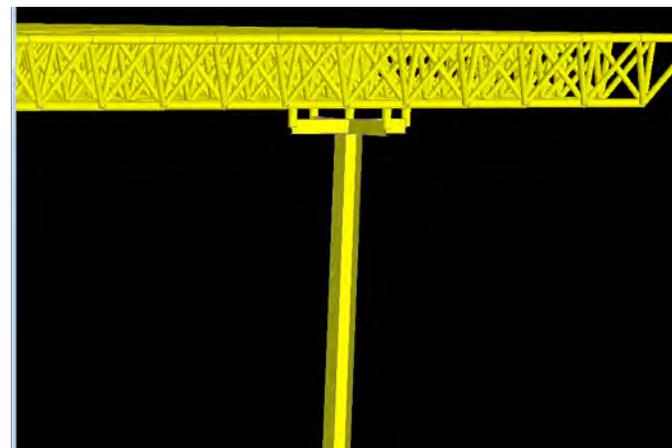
Detalle de apoyo articulado de cuerdas inferiores en columna.
